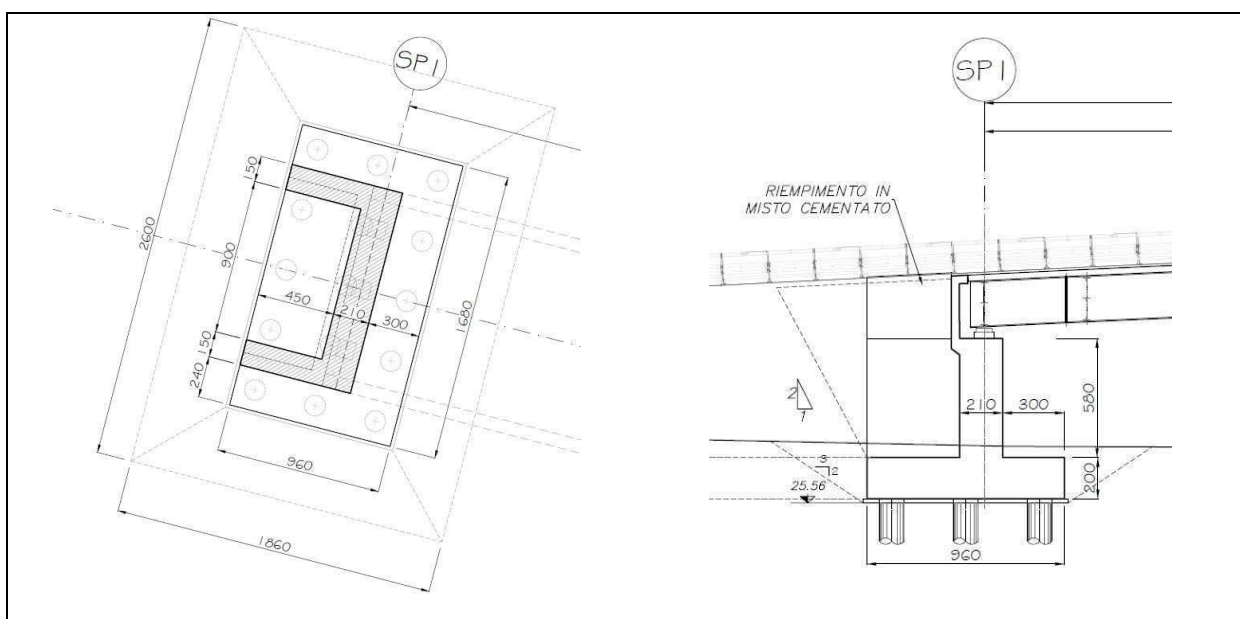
Spalla 1 - Pianta Fondazioni Sezione Fondazioni
